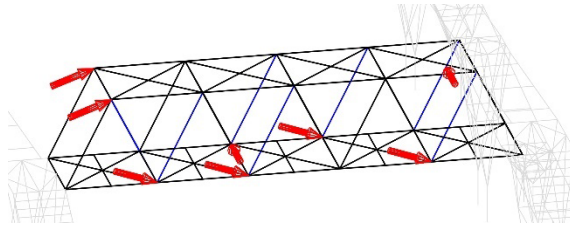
Posición de galgas extensiométricas. En azul se indican los elementos sobre los que hay galgas; las flechas señalan en perpendicular al elemento el punto exacto en que se colocan.
